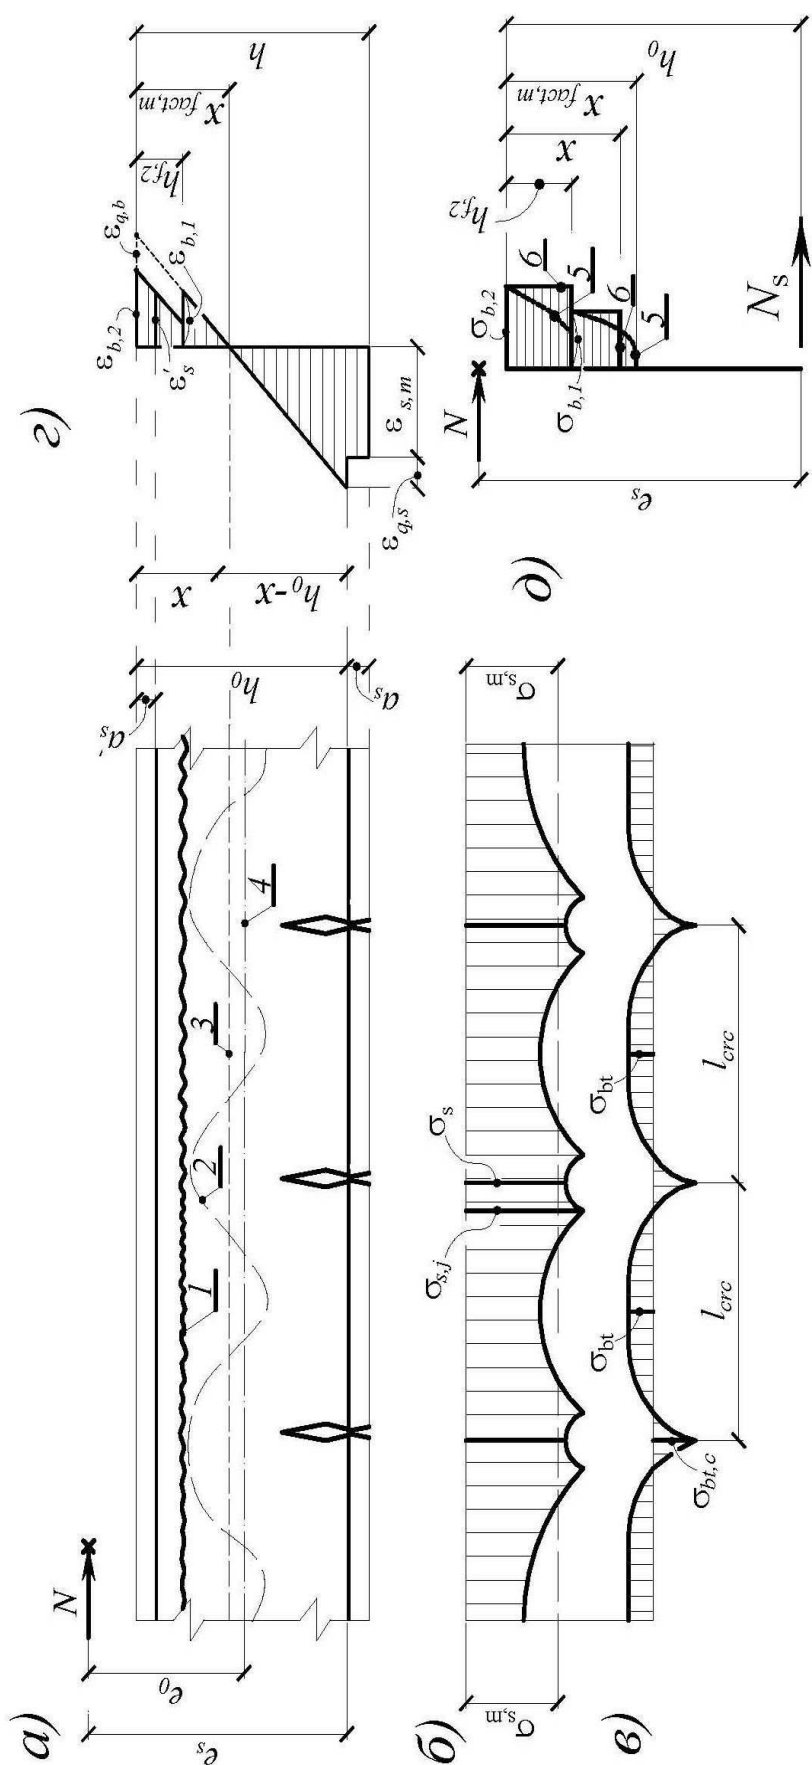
Типичные картины деформирования бетона и арматуры в железобетонном внецентренно сжатом элементе с трещинами при учете эффекта, связанного с нарушением сплошности бетона и условного сосредоточенного сдвига между бетонами и между арматурой и бетоном: а – схема образования трещин; б, в – эпюры напряжений в растянутой арматуре и растянутом бетоне; г – гипотеза средних деформаций в поперечном сечении составного железобетонного элемента; д – внутренние усилия в сечении с трещиной; 1 – шов между бетонами; 2, 3 и 4 – физическая, средняя и геометрическая нейтральные оси, соответственно; 5 – действительные эпюры напряжений сжатия в первом и втором бетоне составного стержня; 6 – то же, принятые для расчета
